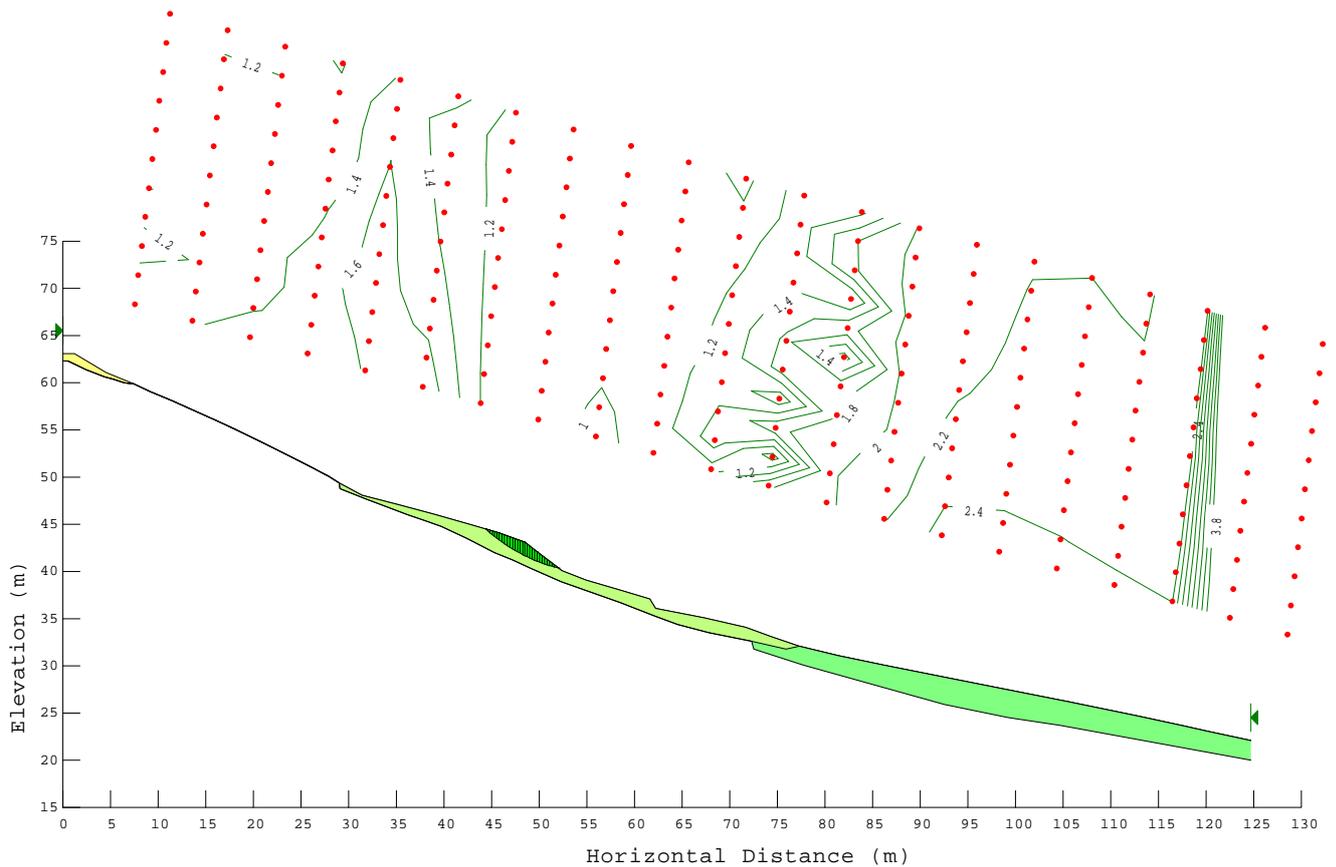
Calcolo di stabilità sulla sezione attuale – Sezione ante operam – superficie di scivolamento con il minor fattore di sicurezza ($F=0.968$).
